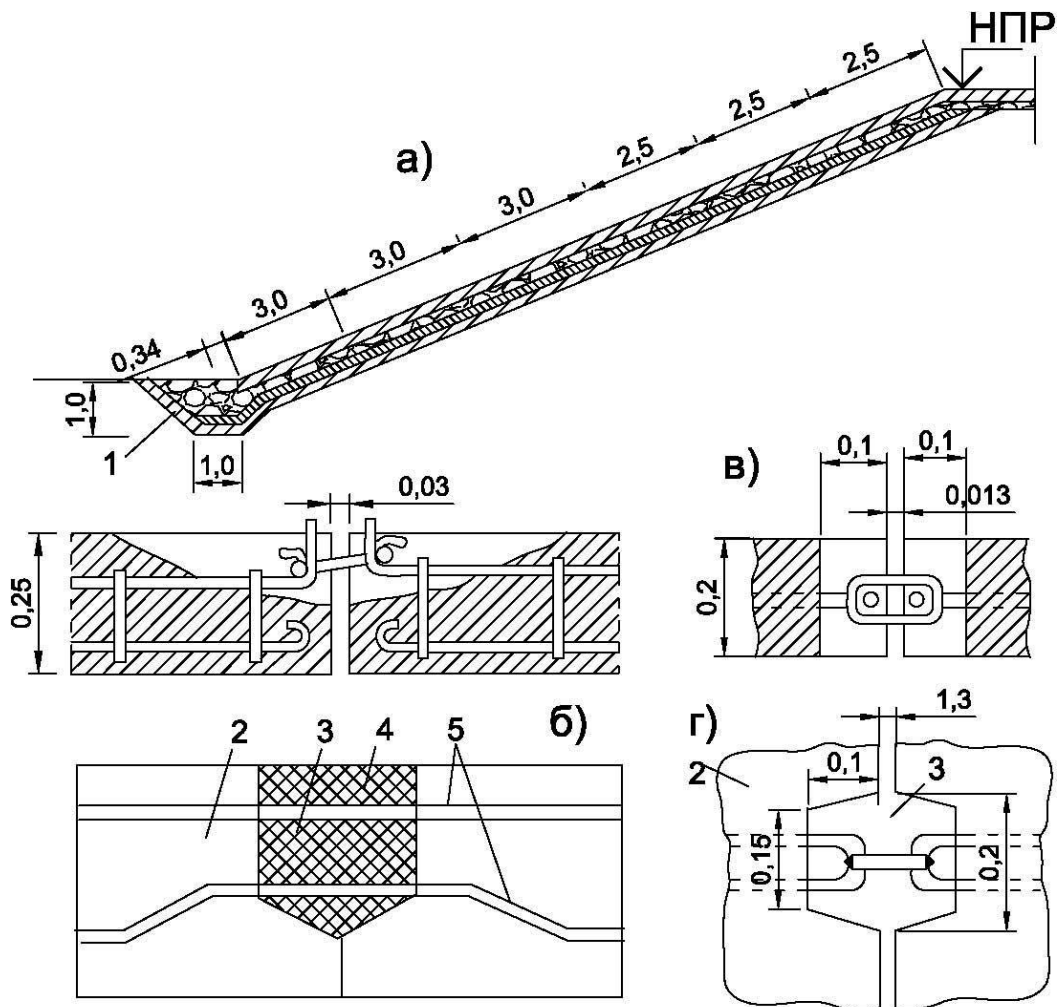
Кріплення укосу збірними залізобетонними плитами:
